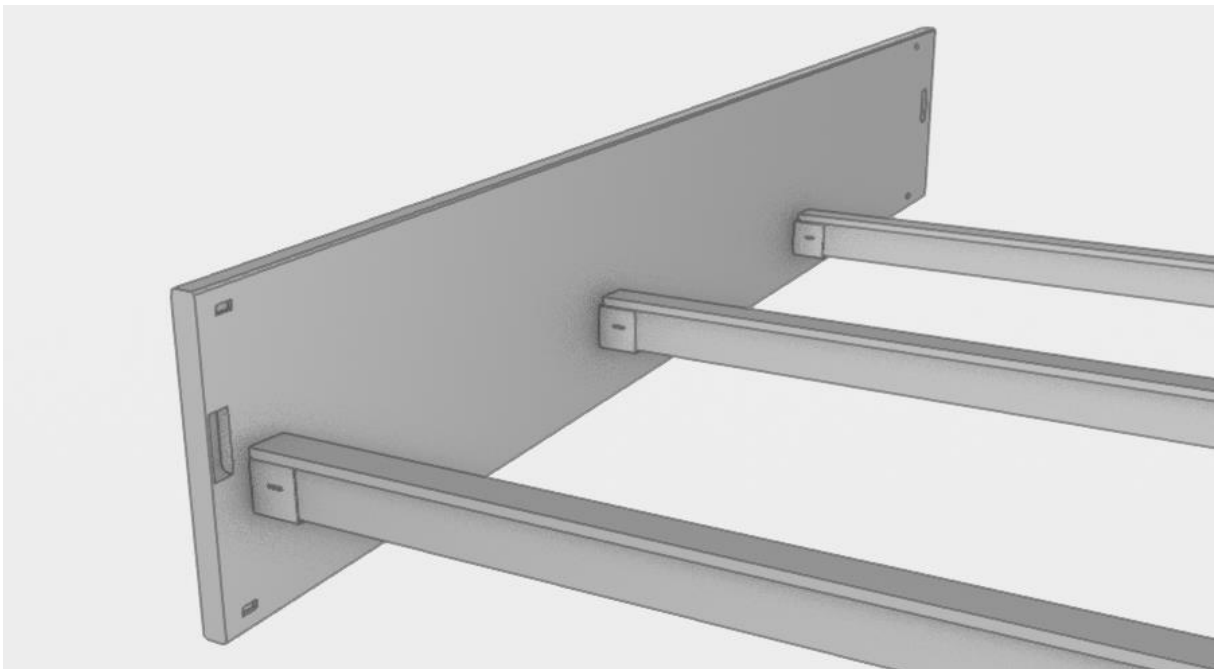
Painel pré-fabricado de concreto apoiando terça.
